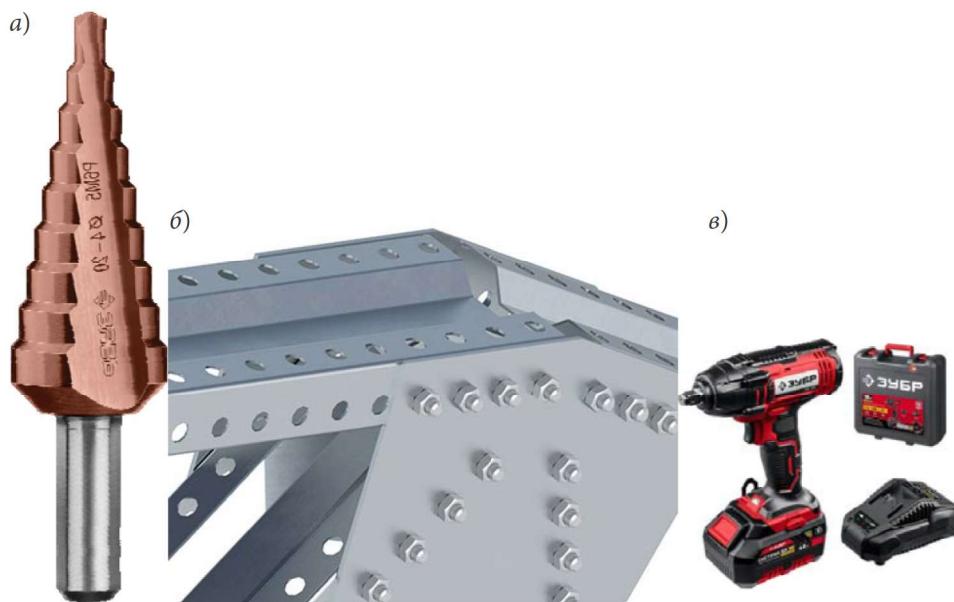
Болтовое соединение и инструмент для сборки каркаса: а — ступенчатое сверло по металлу, применяется для подгонки отверстий в стальных профилях при сборке каркаса; б — болтовое соединение стальных оцинкованных профилей; в — гайковерт аккумуляторный для сборки болтовых соединений
